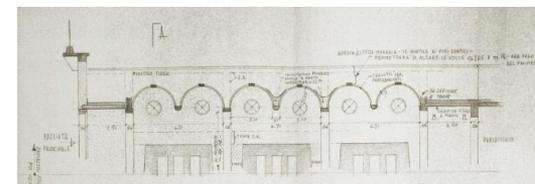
Dettaglio dell'intradosso, seconda soluzione per la Chiesa di Maria SS. del Rosario (1953) – Archivio Paride Pozzi
